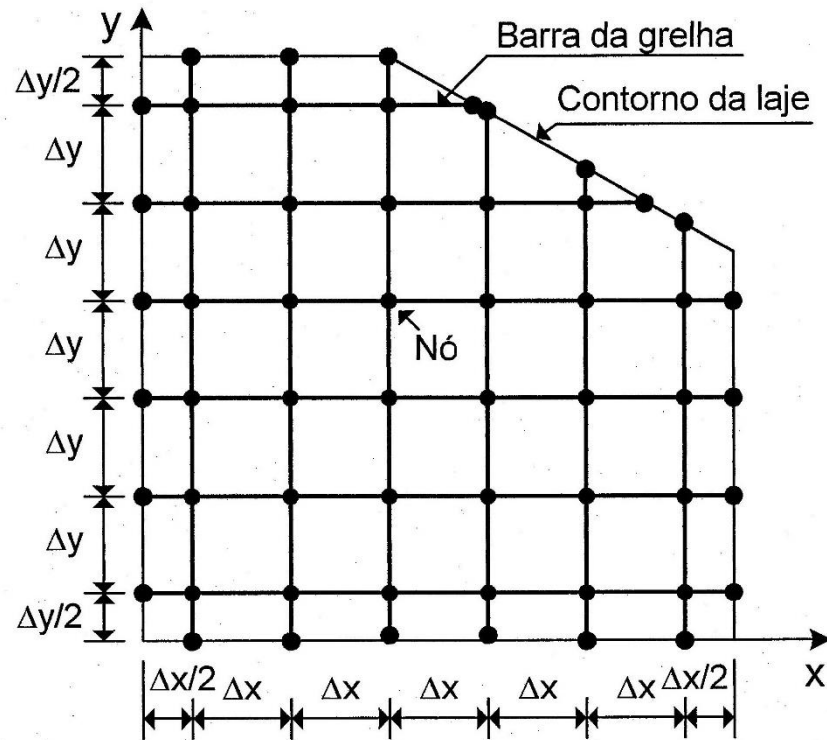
Discretização de laje poligonal em barras de grelha.
